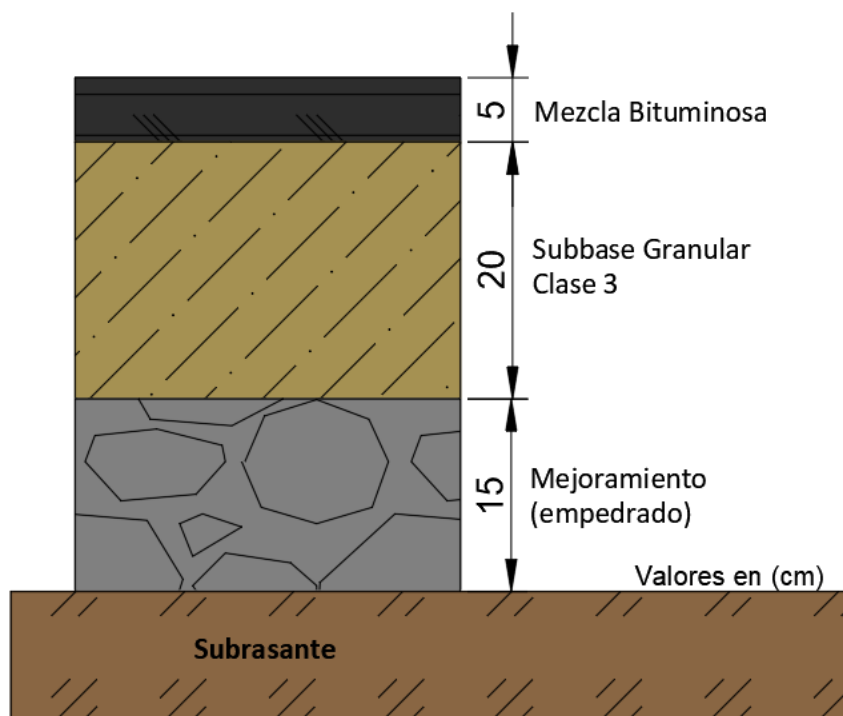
Estructura de pavimento final para los tramos empedrados en la vía CERCOPAMBA.
